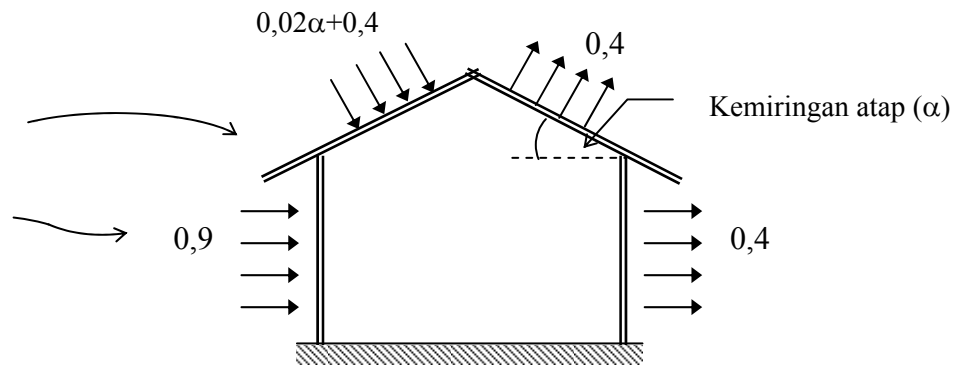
Pengaruh Angin pada Bangunan Gedung
